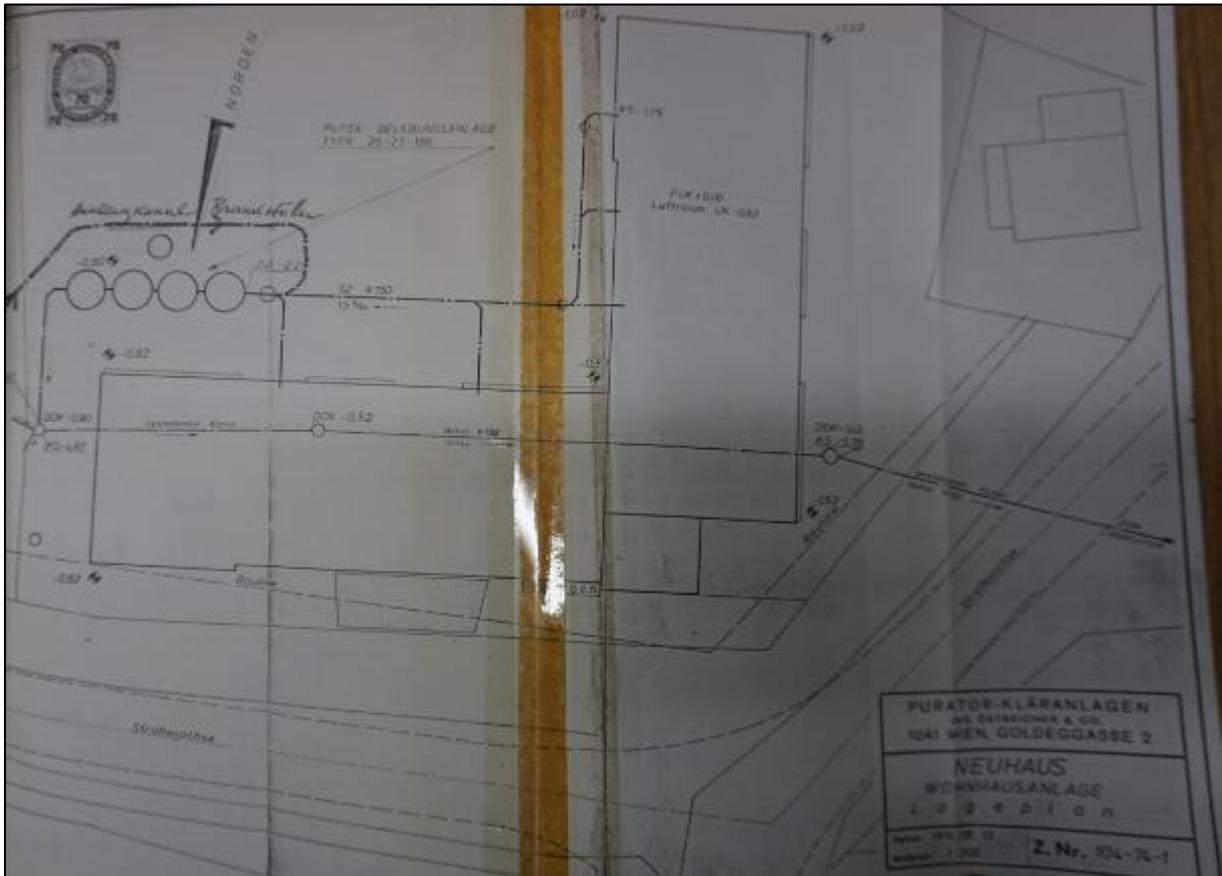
Lageplan, Planunterlage (Plan-Nr. 104-74-1) vom 13. August 1974³¹
